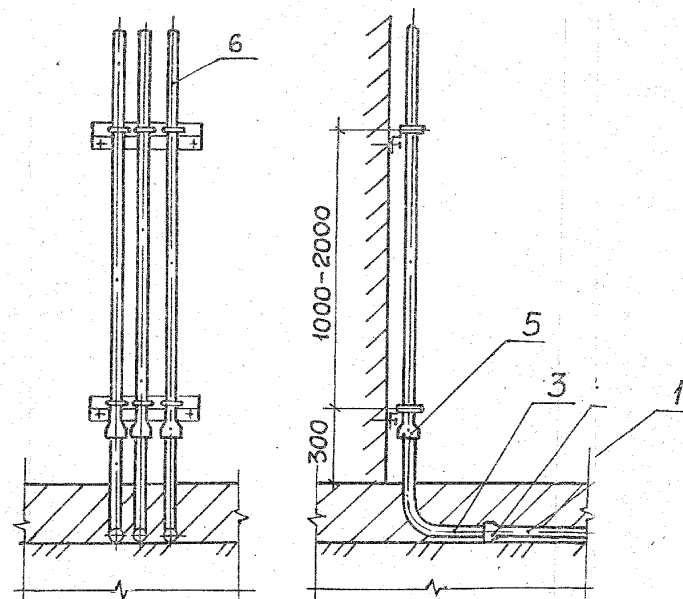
Прокладка труб из П. без защиты от механических повреждений.
